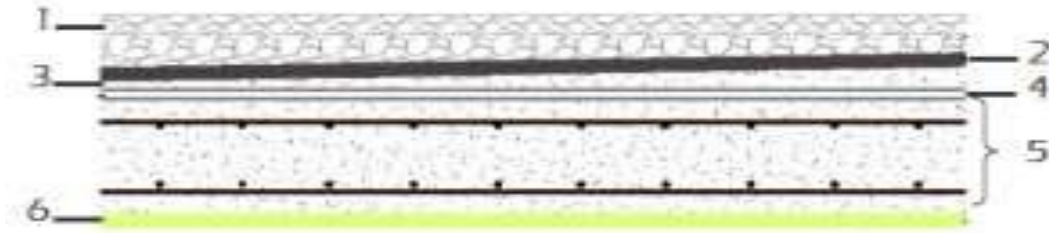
Coupe d'un plancher en dalle pleine (inaccessible).
